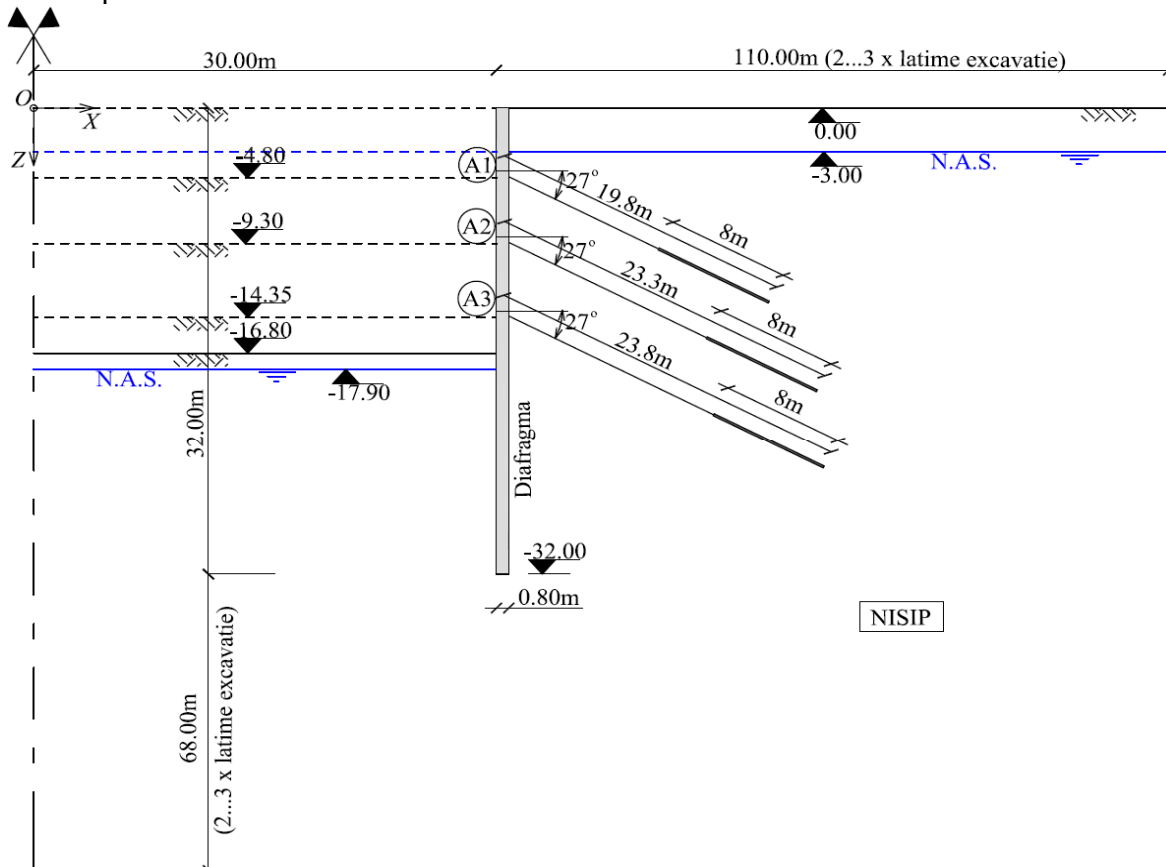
Geometrie sistem de sprijin ancorat, conf. H. F. Schweiger, [A.168].
